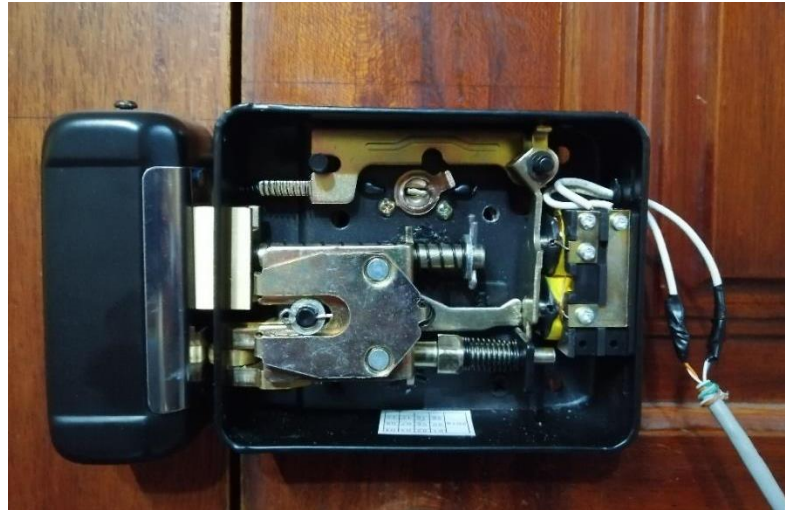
Instalación de cerradura eléctrica. Fuente: Elaborado por el autor
